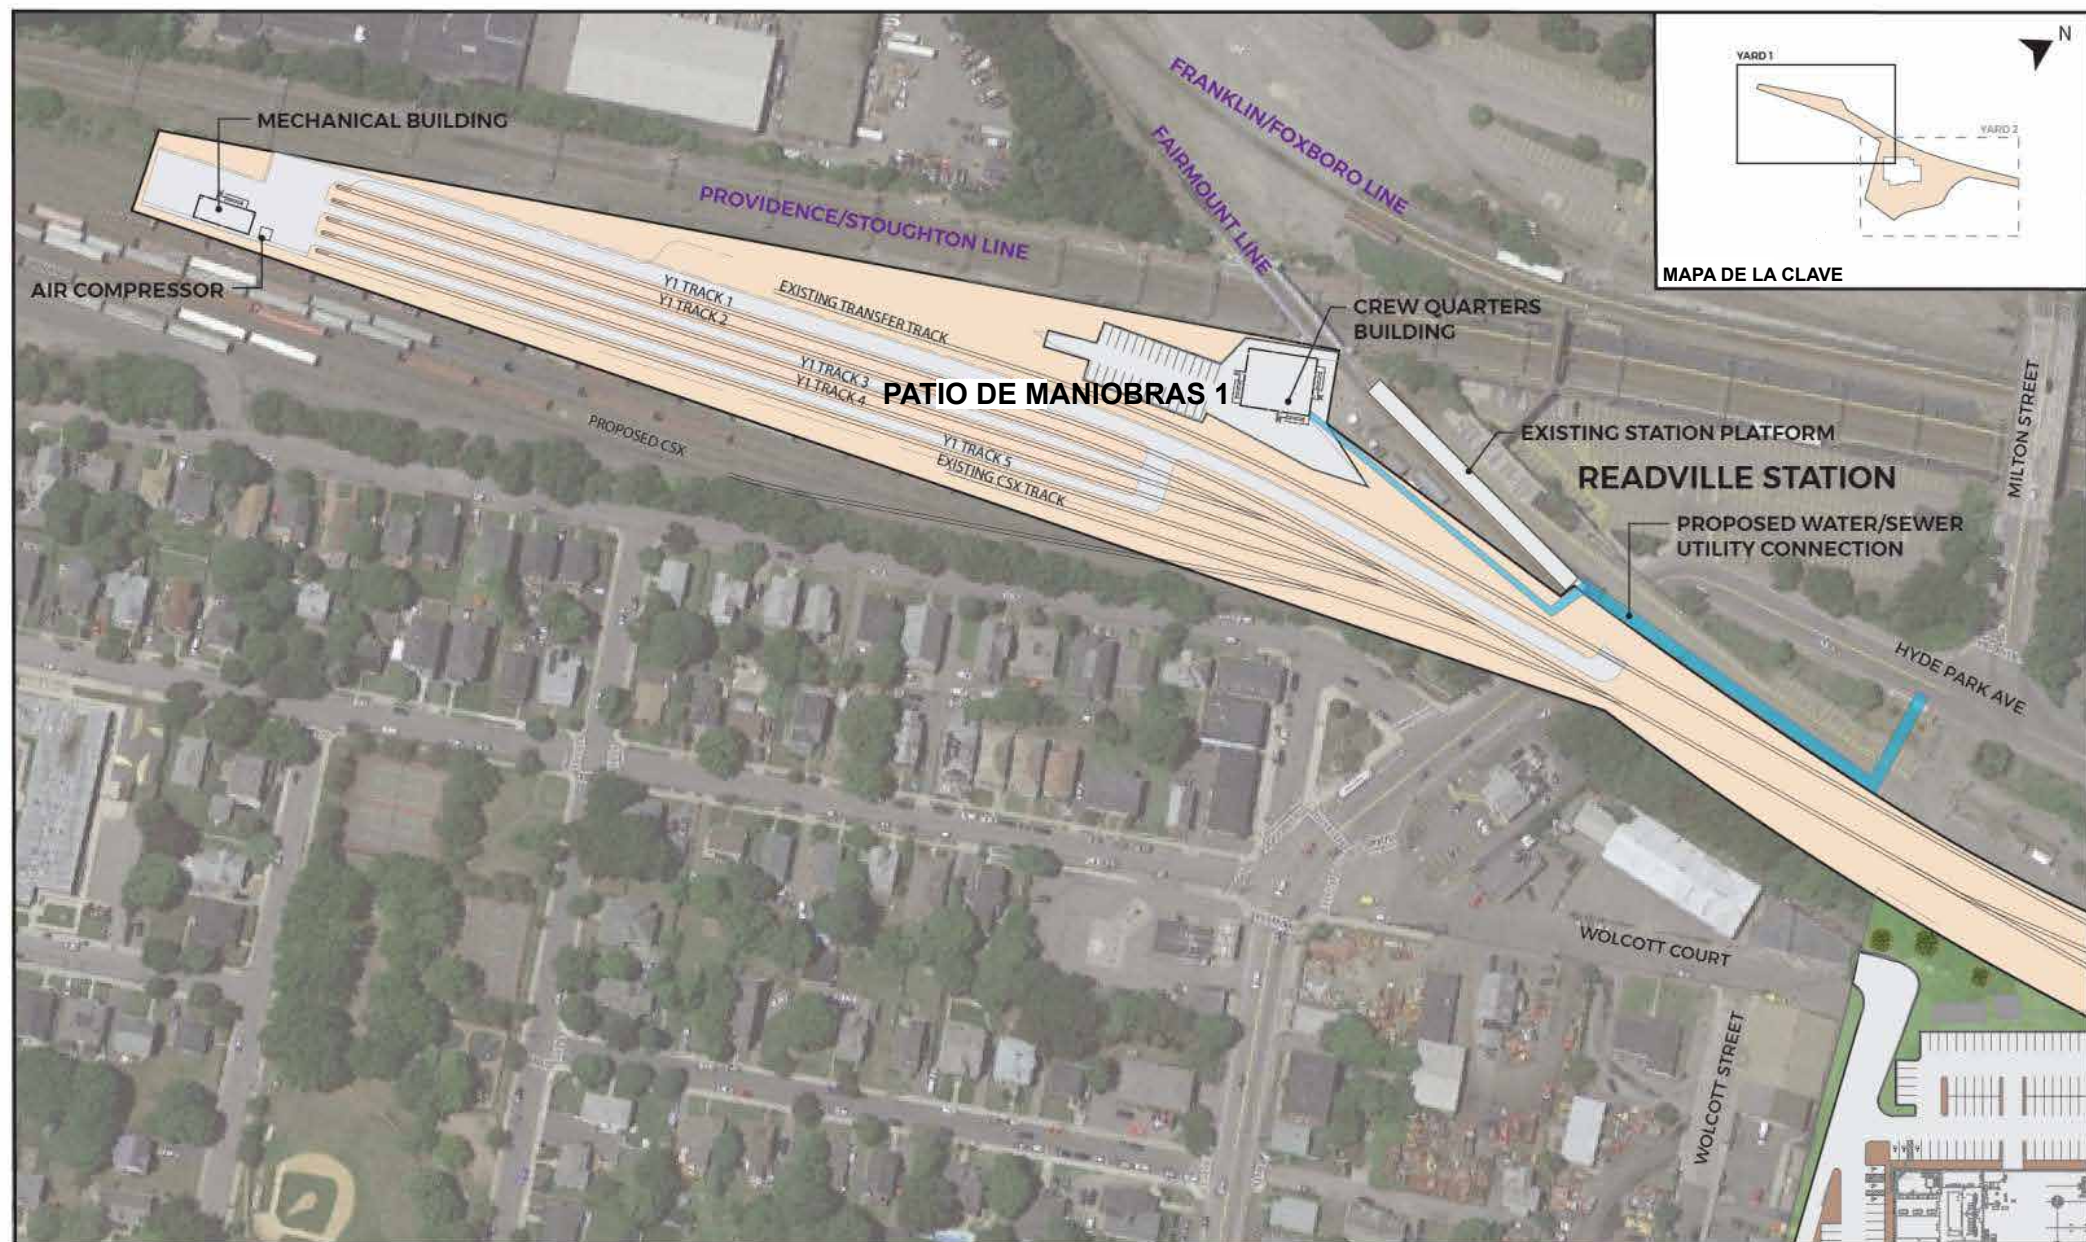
PLANO ESQUEMÁTICO DEL EMPLAZAMIENTO DEL LADO SUR DE LA INSTALACIÓN DE MANTENIMIENTO Y PARADA - PATIO 1
